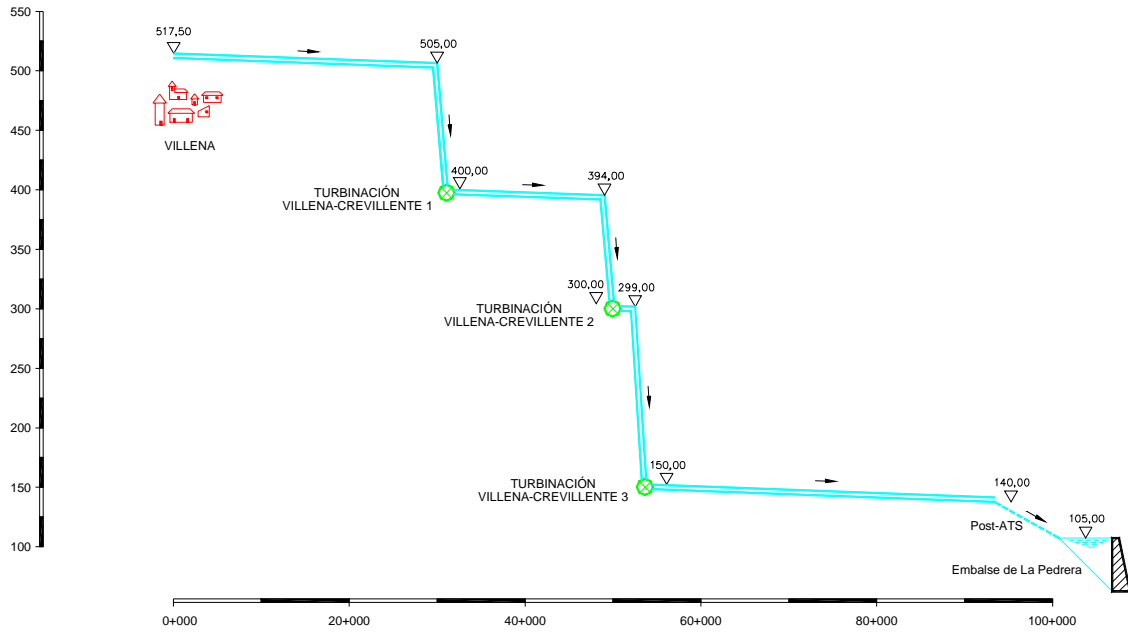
Conducción Villena - Bajo Segura. Esquema en alzado
